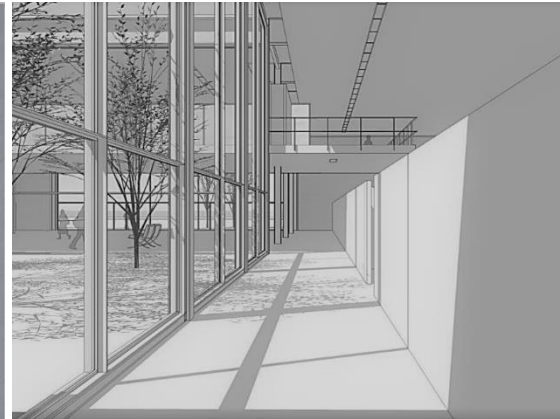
PLANTA BAJA ITT BUILDING FUENTE: [HTTPS://WWW.TESISENRED.NET](https://www.tesisenred.net)
